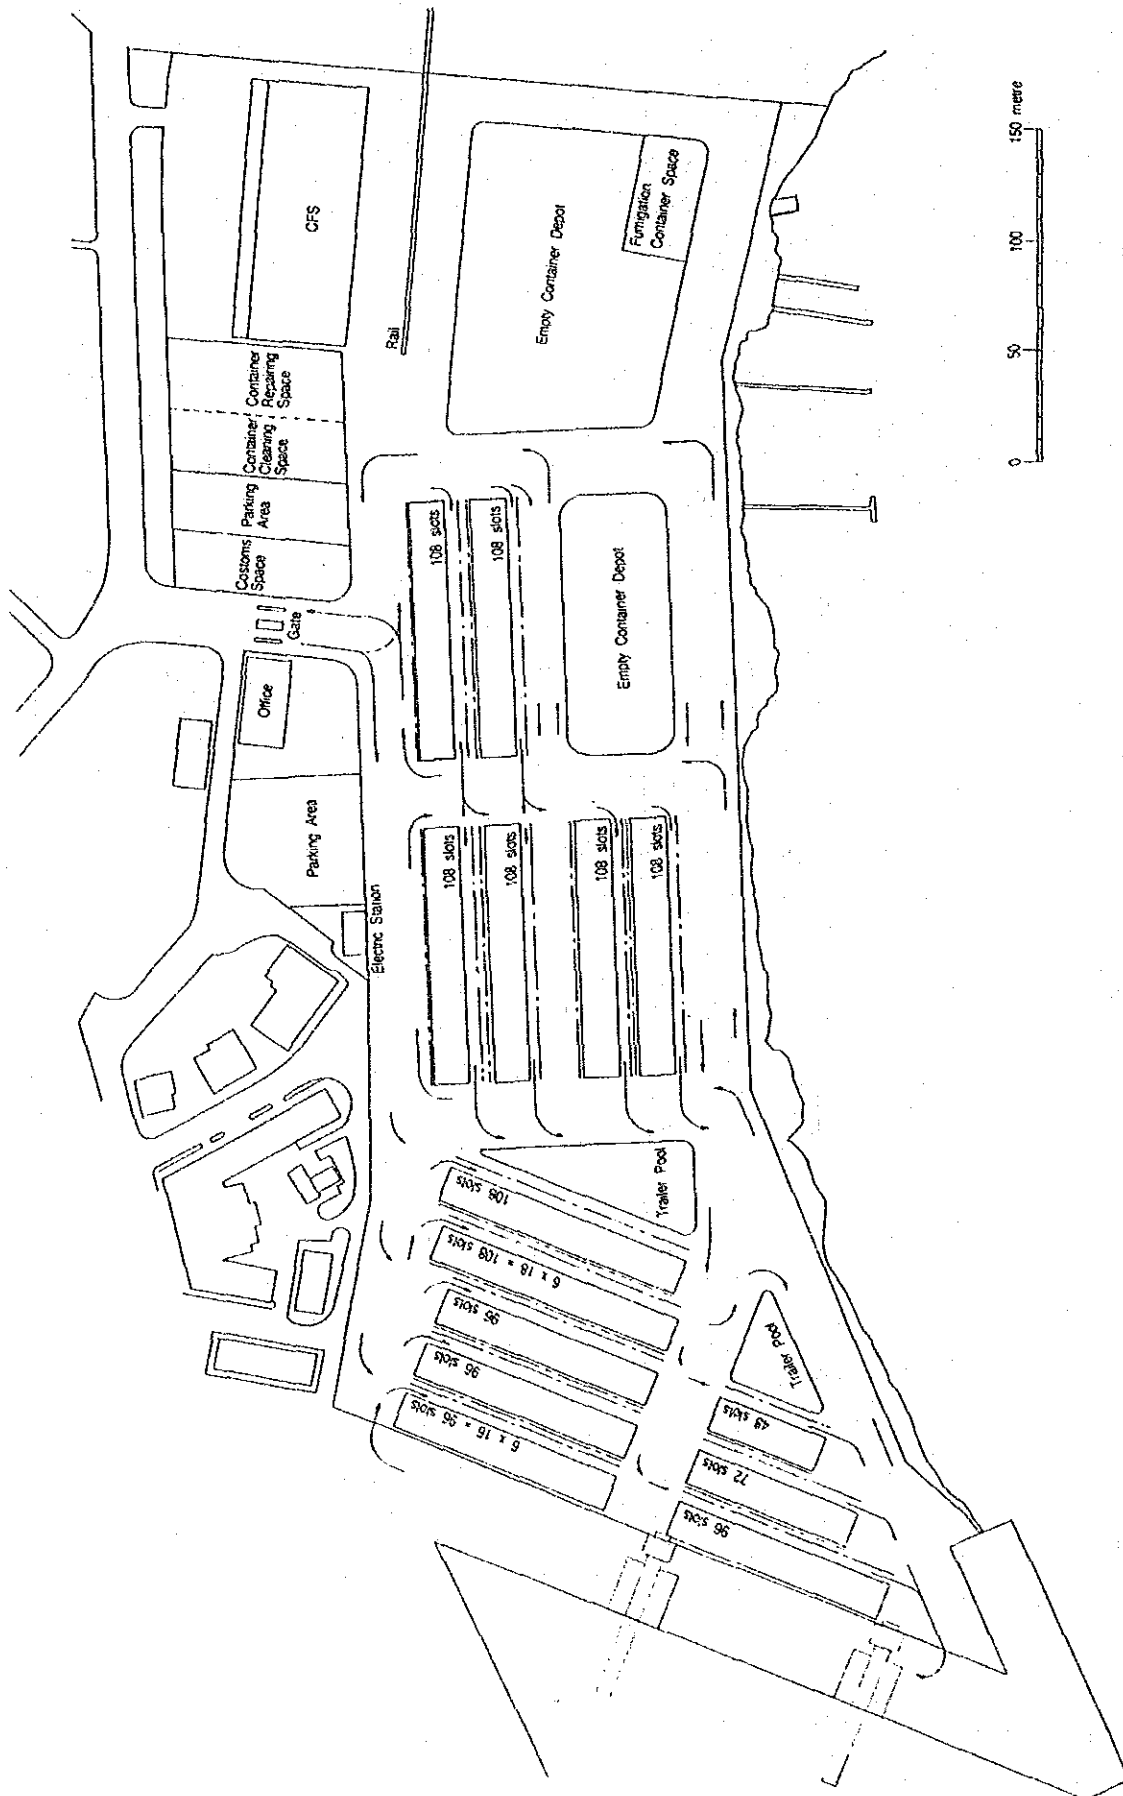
Plano del Terminal de Contenedores en 2010
